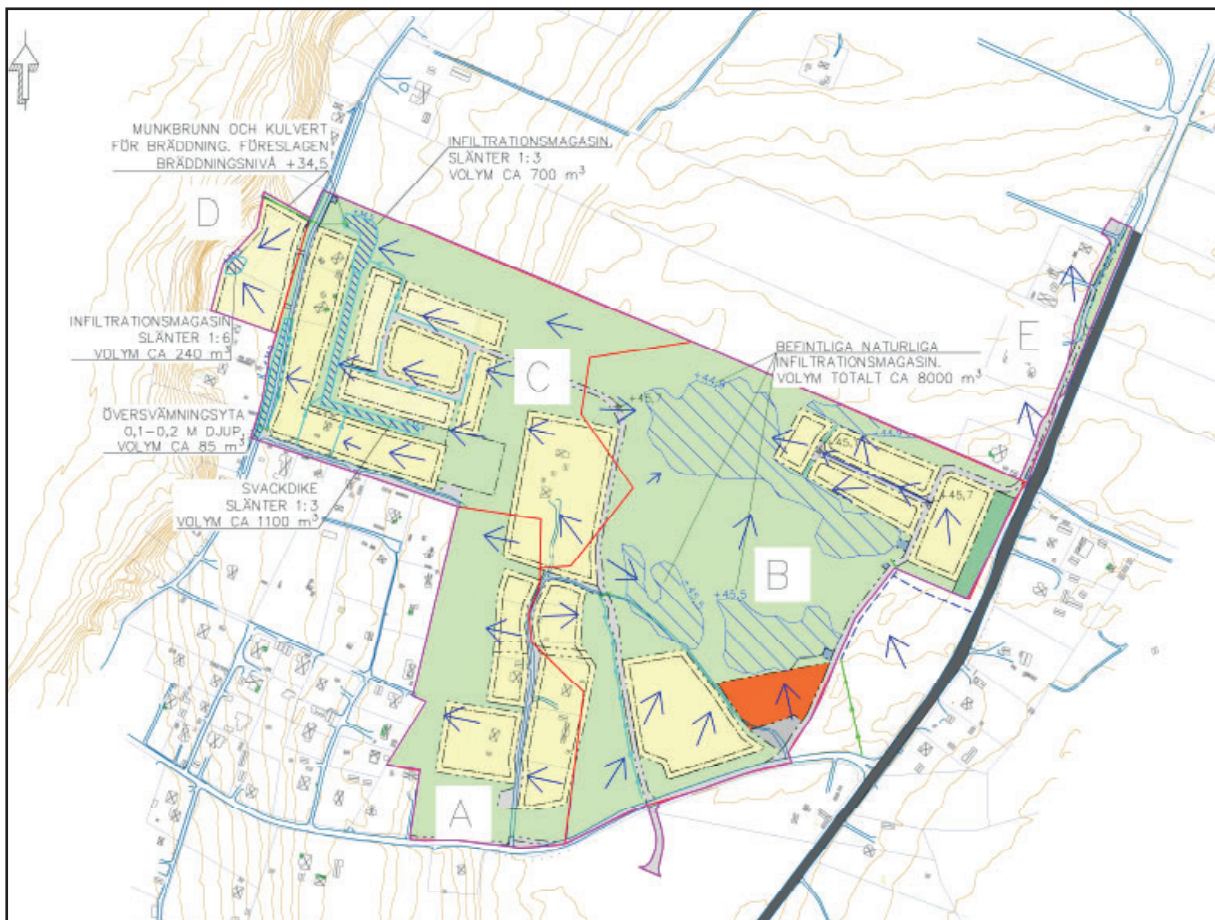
Förslag på avvattningsplan enligt dagvattenutredning. De mörkblå markeringarna är fördröjningssystem och de ljusblå pilarna är diken. De mörkblå pilarna illustrerar vattnets naturliga väg i landskapet. Justeringar har skett i planförslaget efter att utredningen togs fram.
